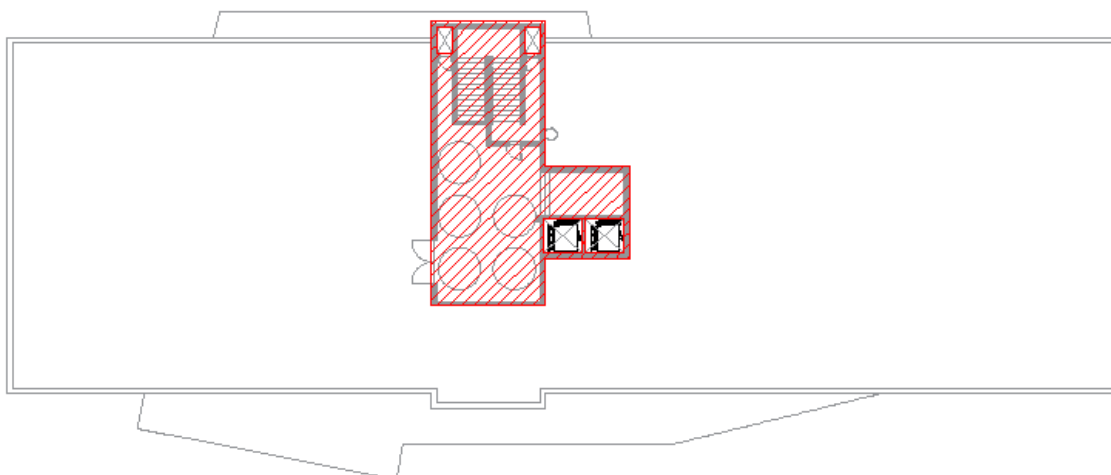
Área considerada para pavimento tipo (Pavimento Técnico)
